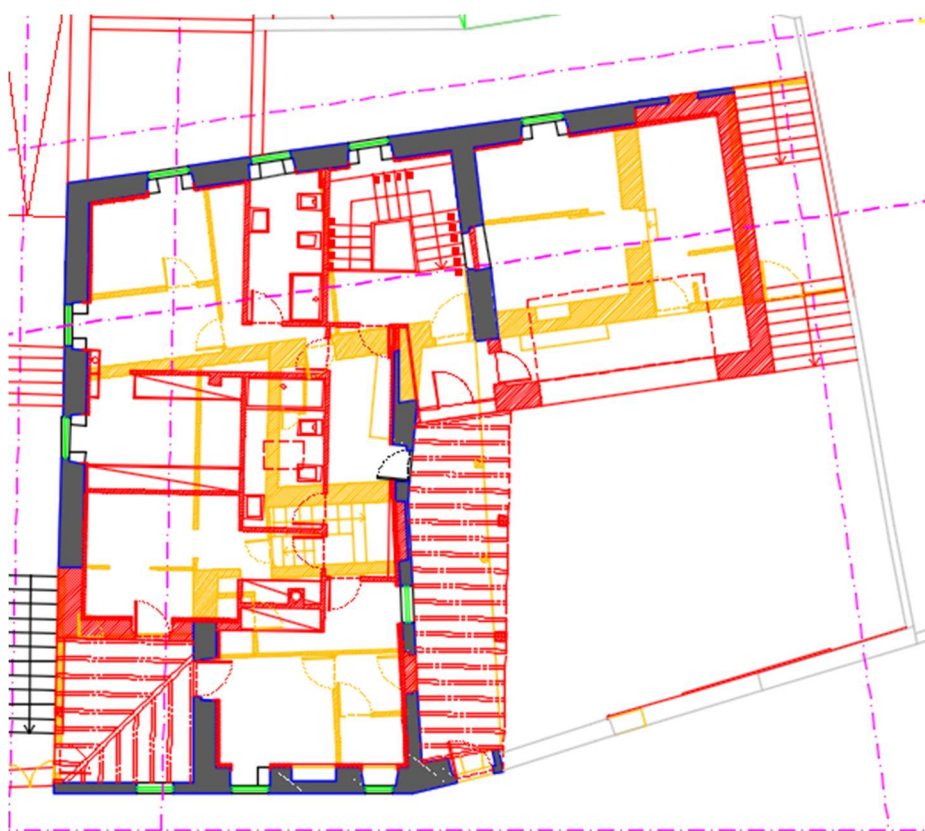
Planta de arquitetura do a rés-do-chão - vermelhos e amarelos (planta sem escala).
